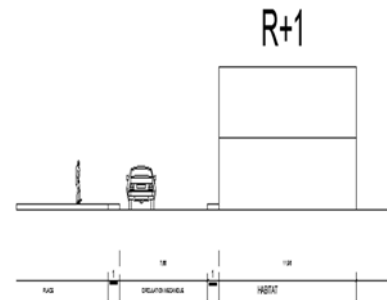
Coupe sur route Aissat Idir (source : auteur)
